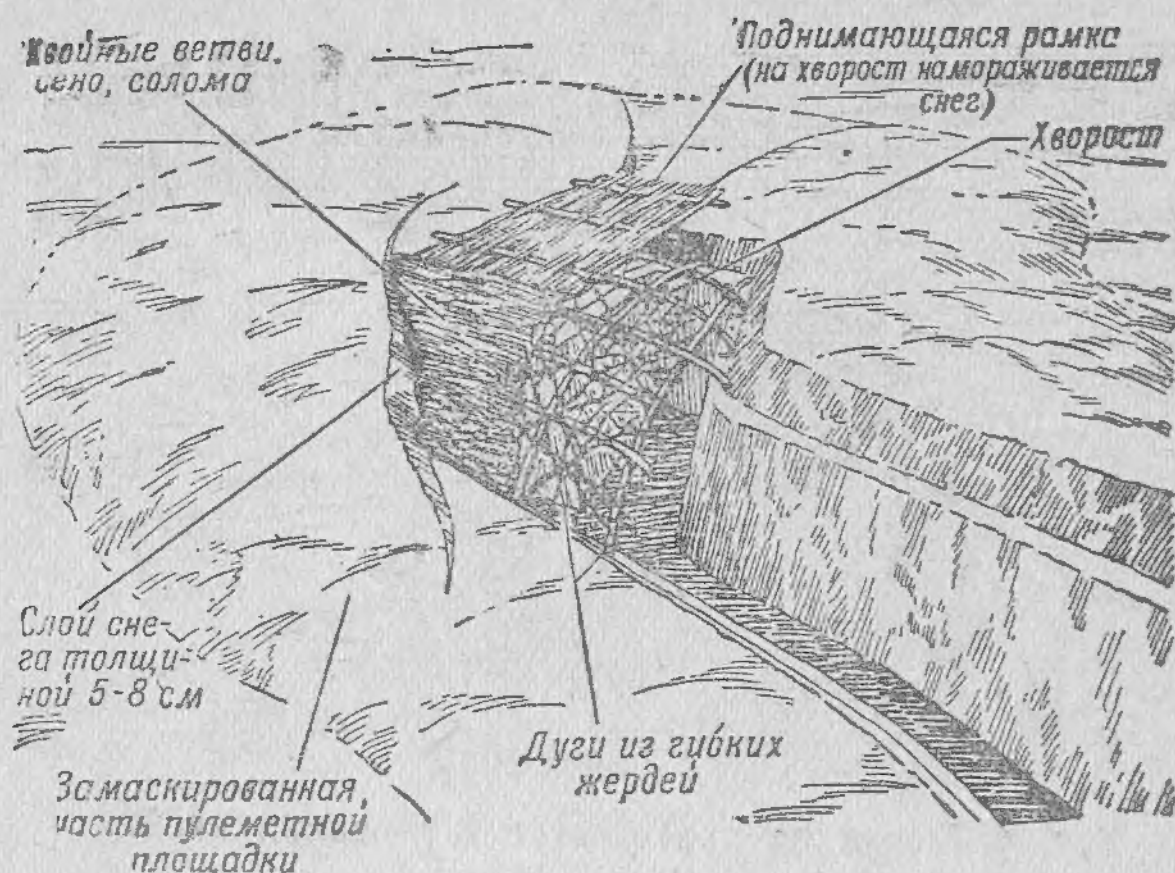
Выпуклое перекрытие для пулеметной площадки
